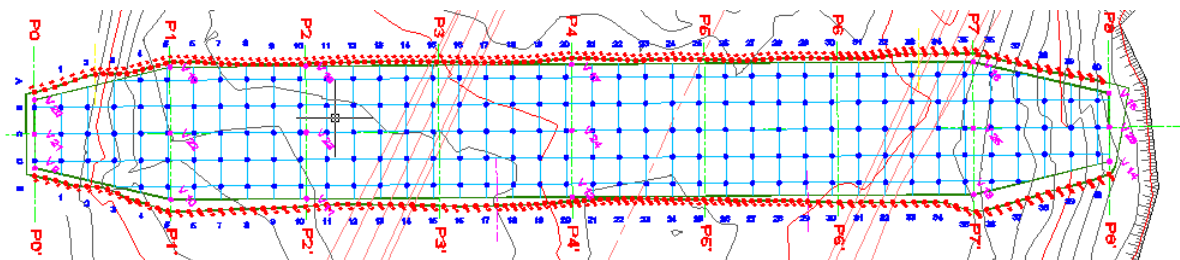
Planta da Malha de Pré-Corte da Ensecadeira, (SETH, 2012).
